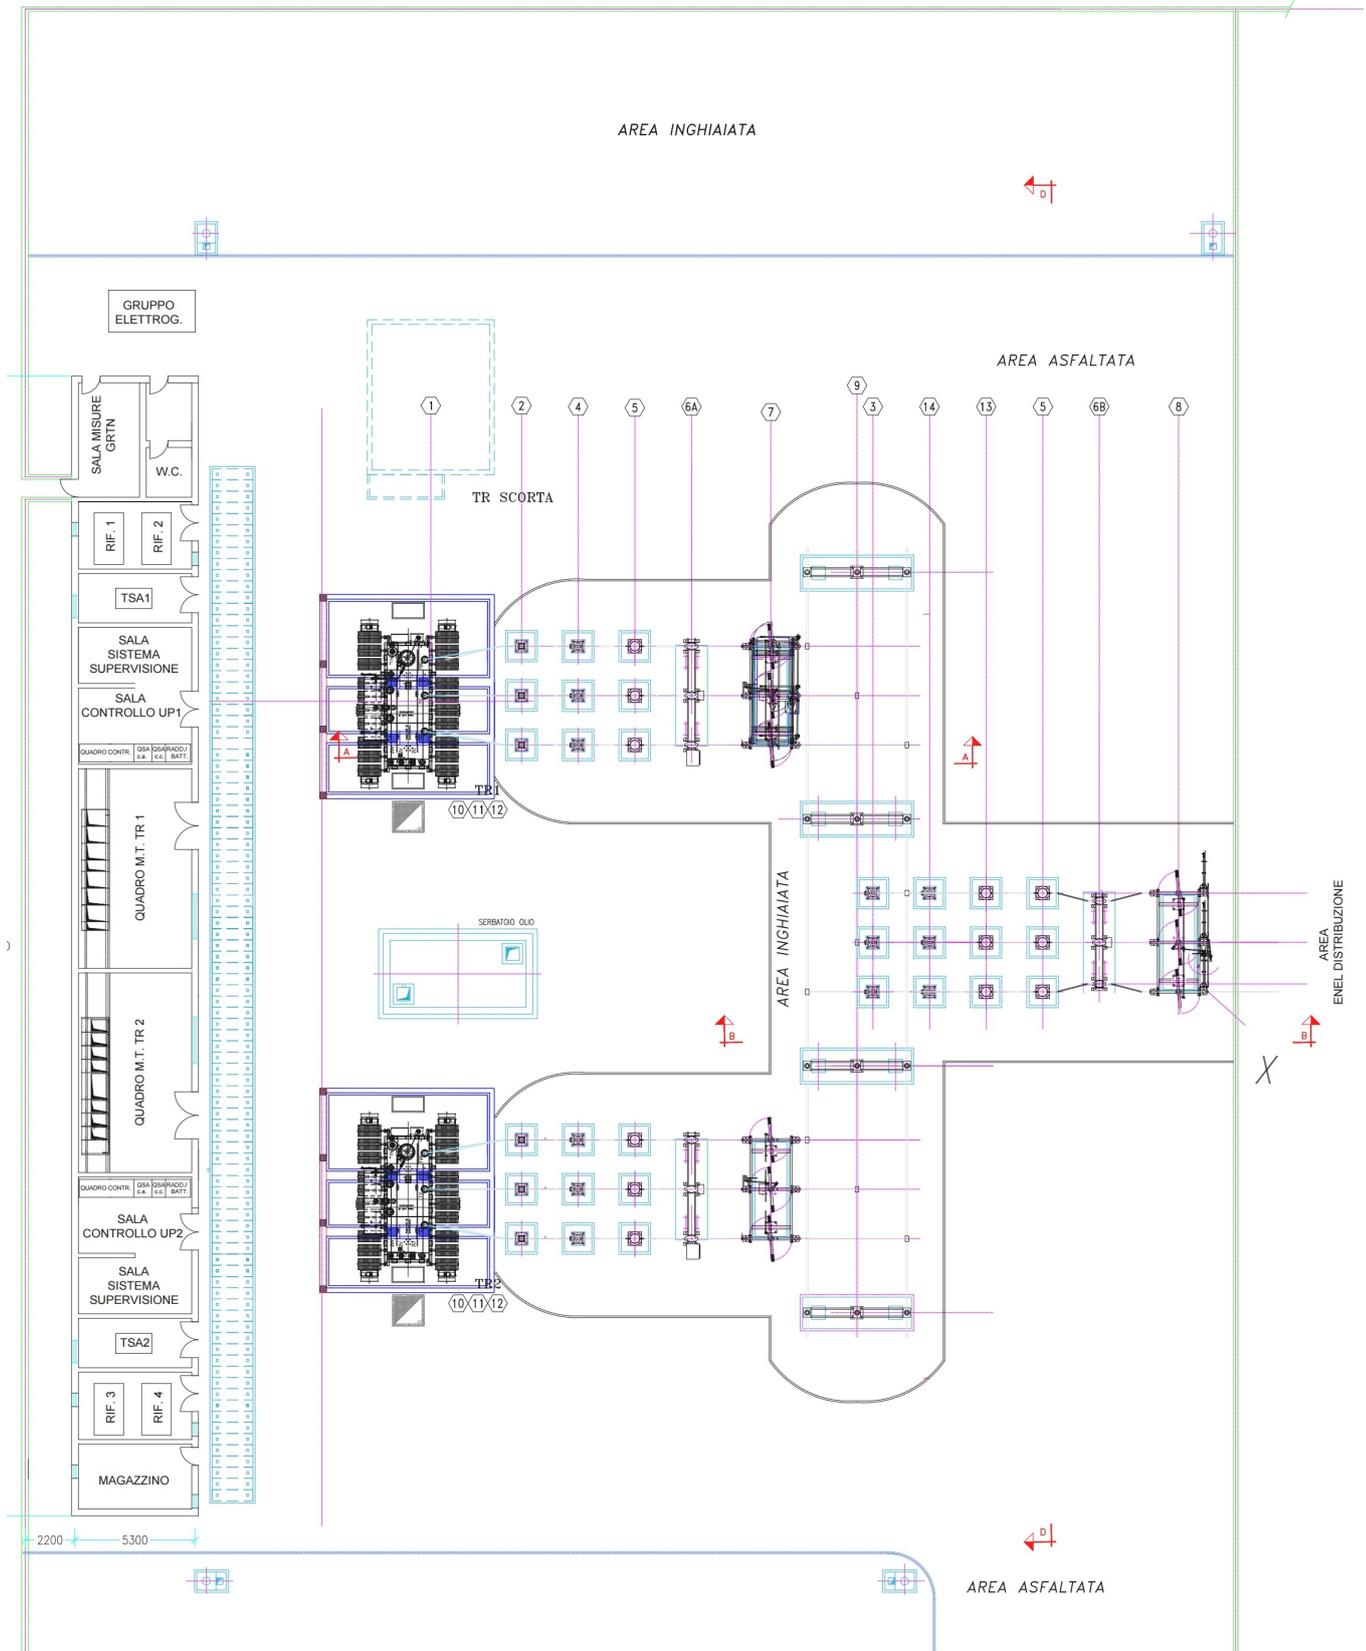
Planimetria apparecchiature elettromeccaniche
